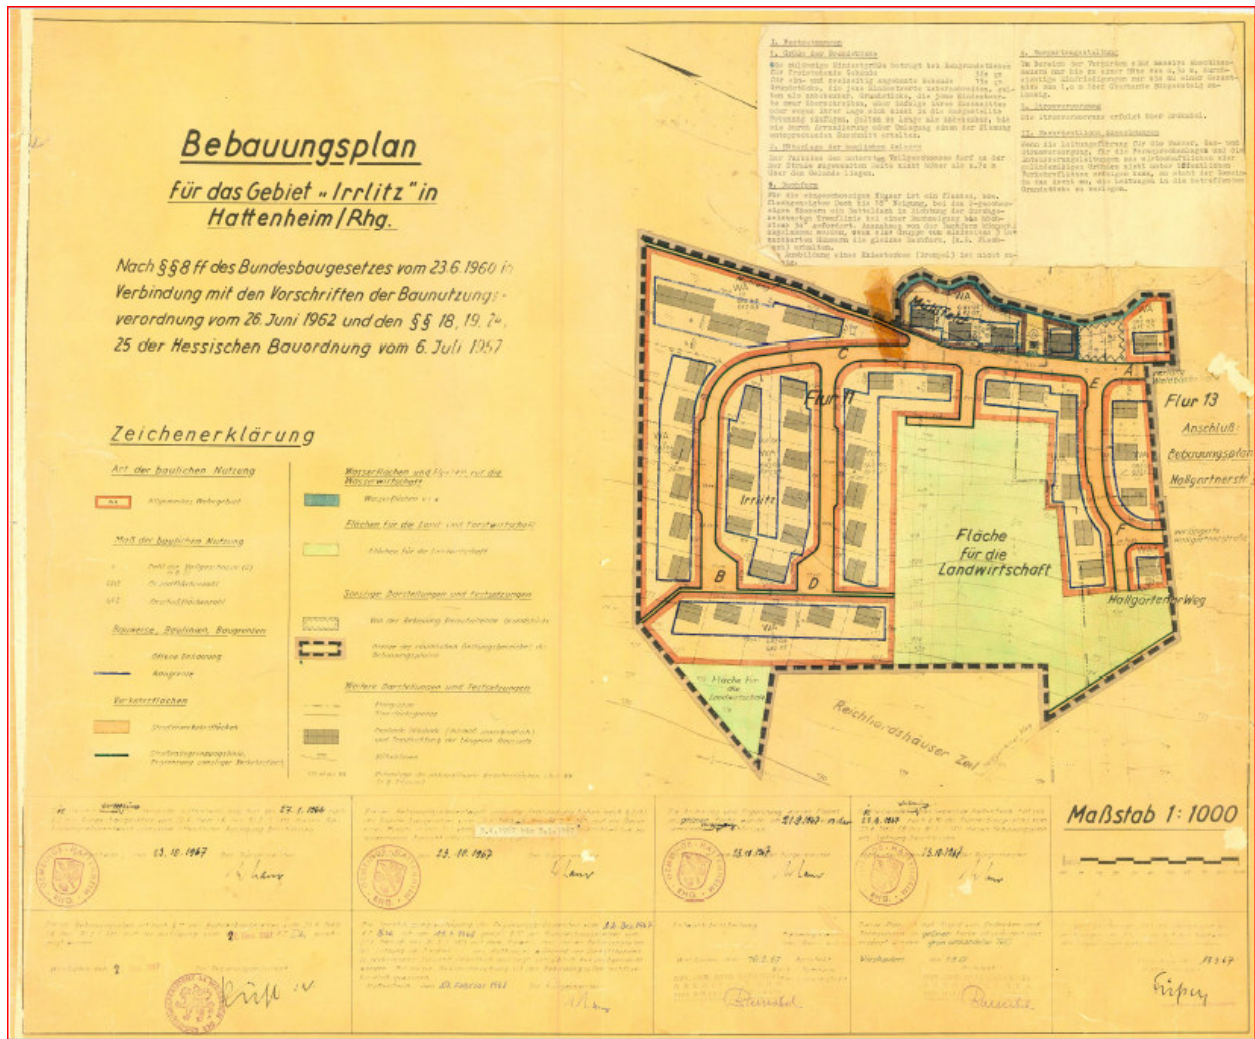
Bebauungsplan „Irrlitz“ (unmaßstäblich)
